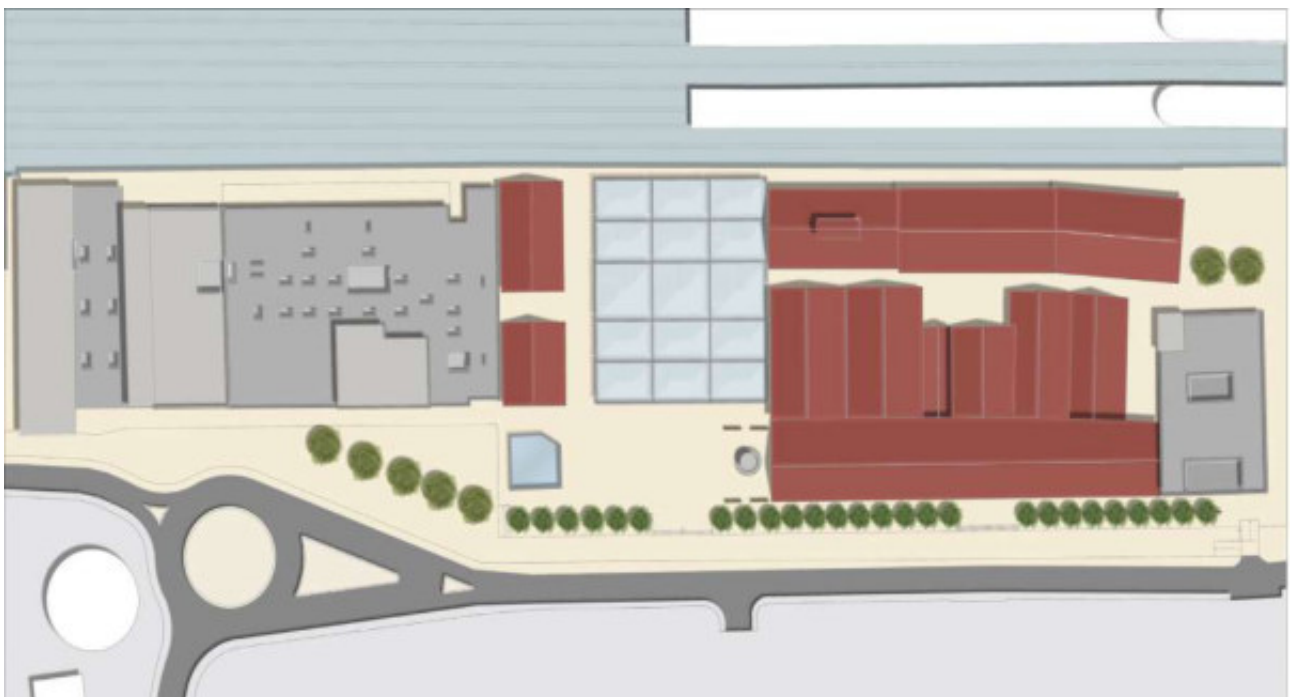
Rappresentazione schematica del Progetto preliminare approvato nel 2014
